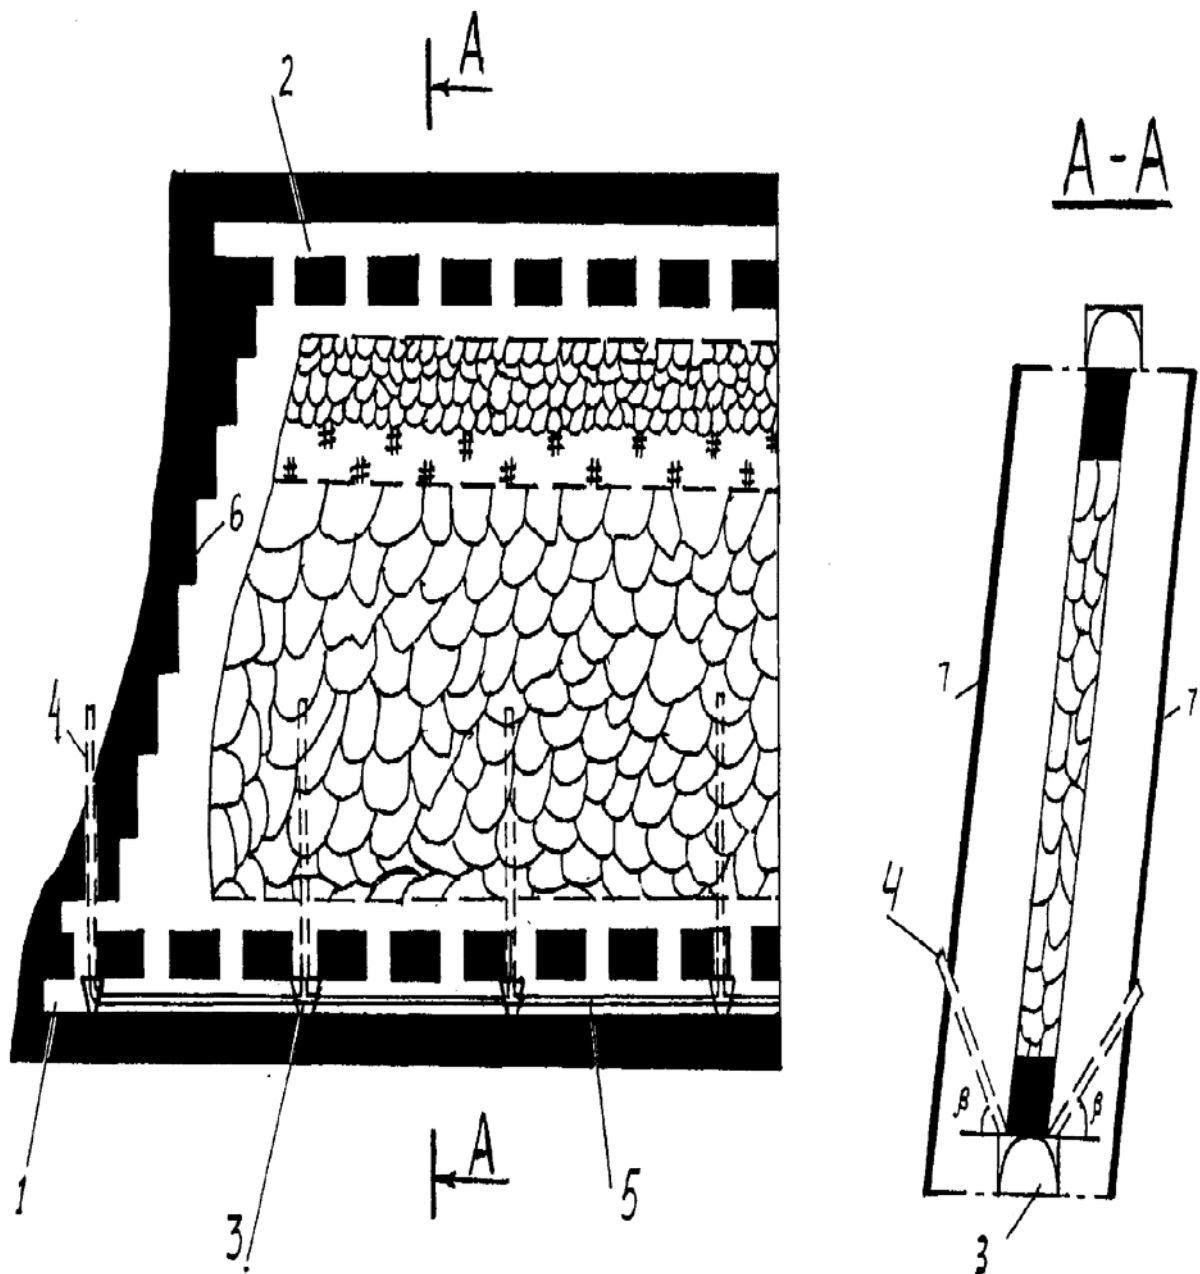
Схема дегазации крутых сближенных пластов скважинами, пробуренными из выработок разрабатываемого пласта при сплошной системе разработки:
